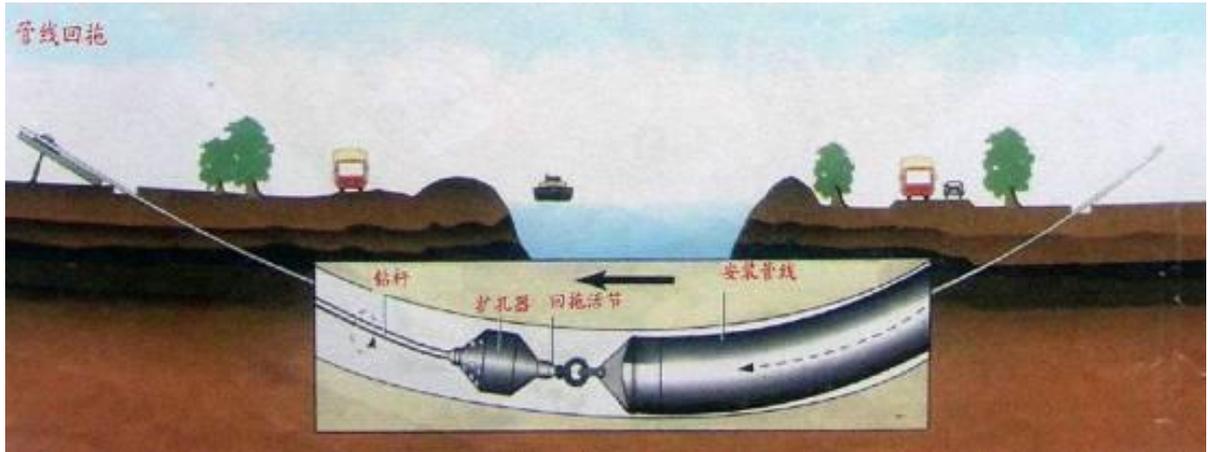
定向钻穿越施工管线回拖过程断面示意图
